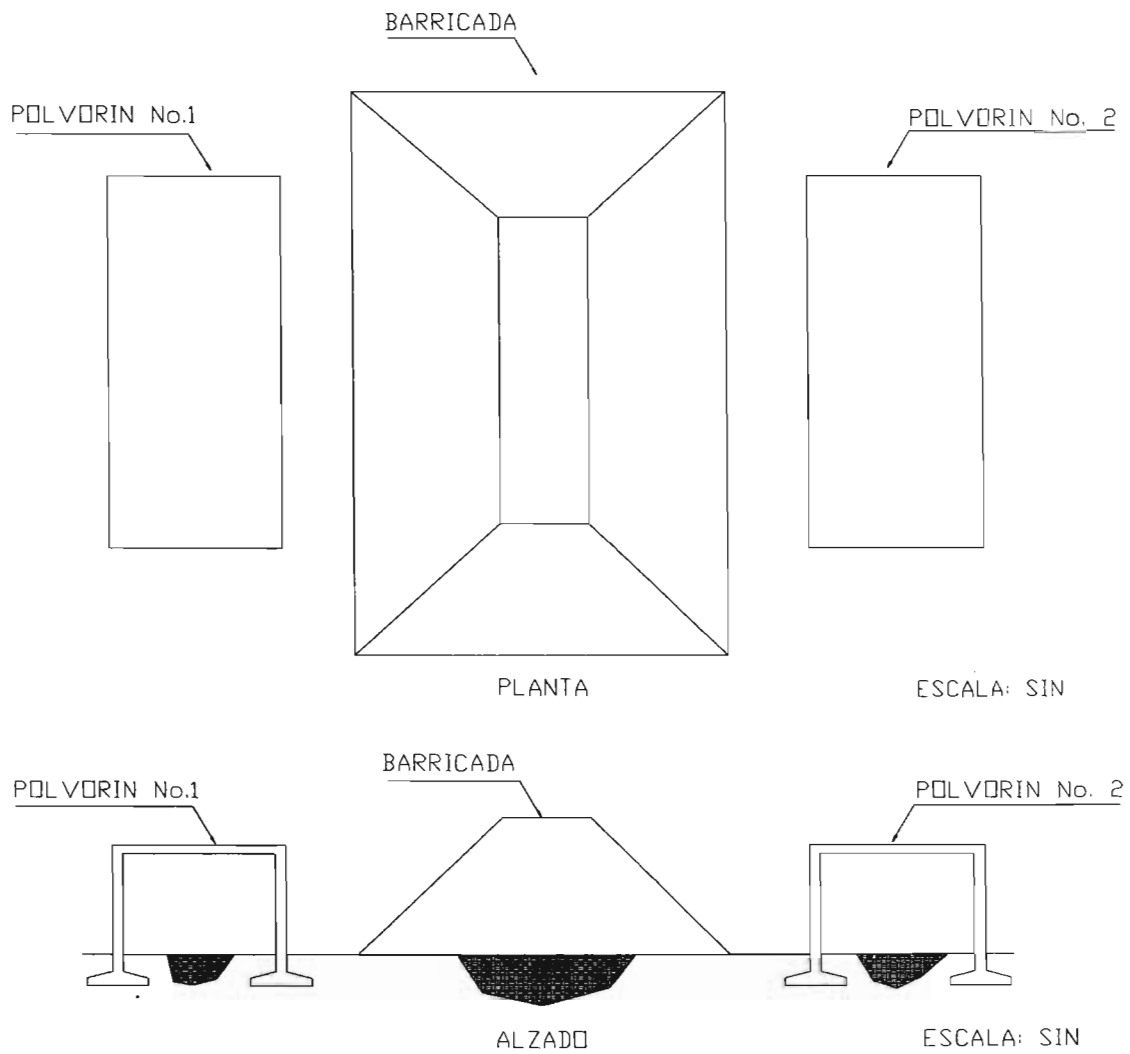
Estructura de muros colados en el sitio con protección tipo merlón o barricada.
